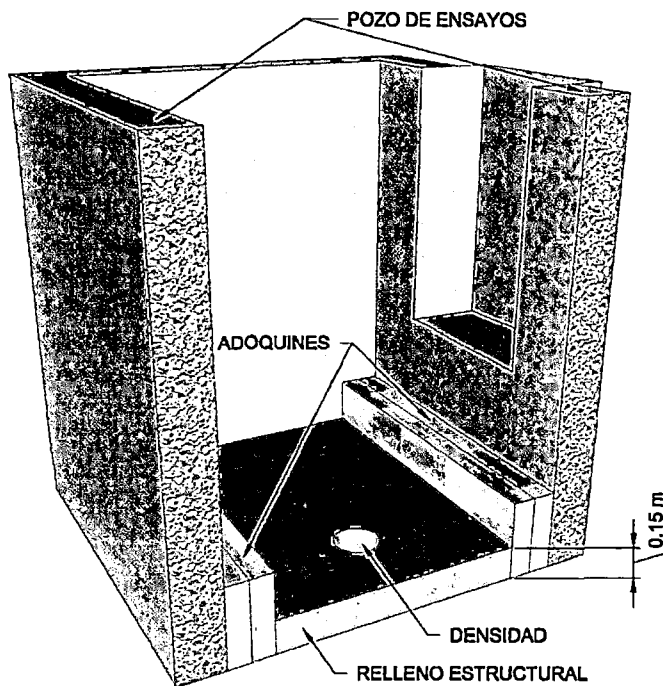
Vista en tres dimensiones del ensayo SC N°1 - Suelo de cimentación
